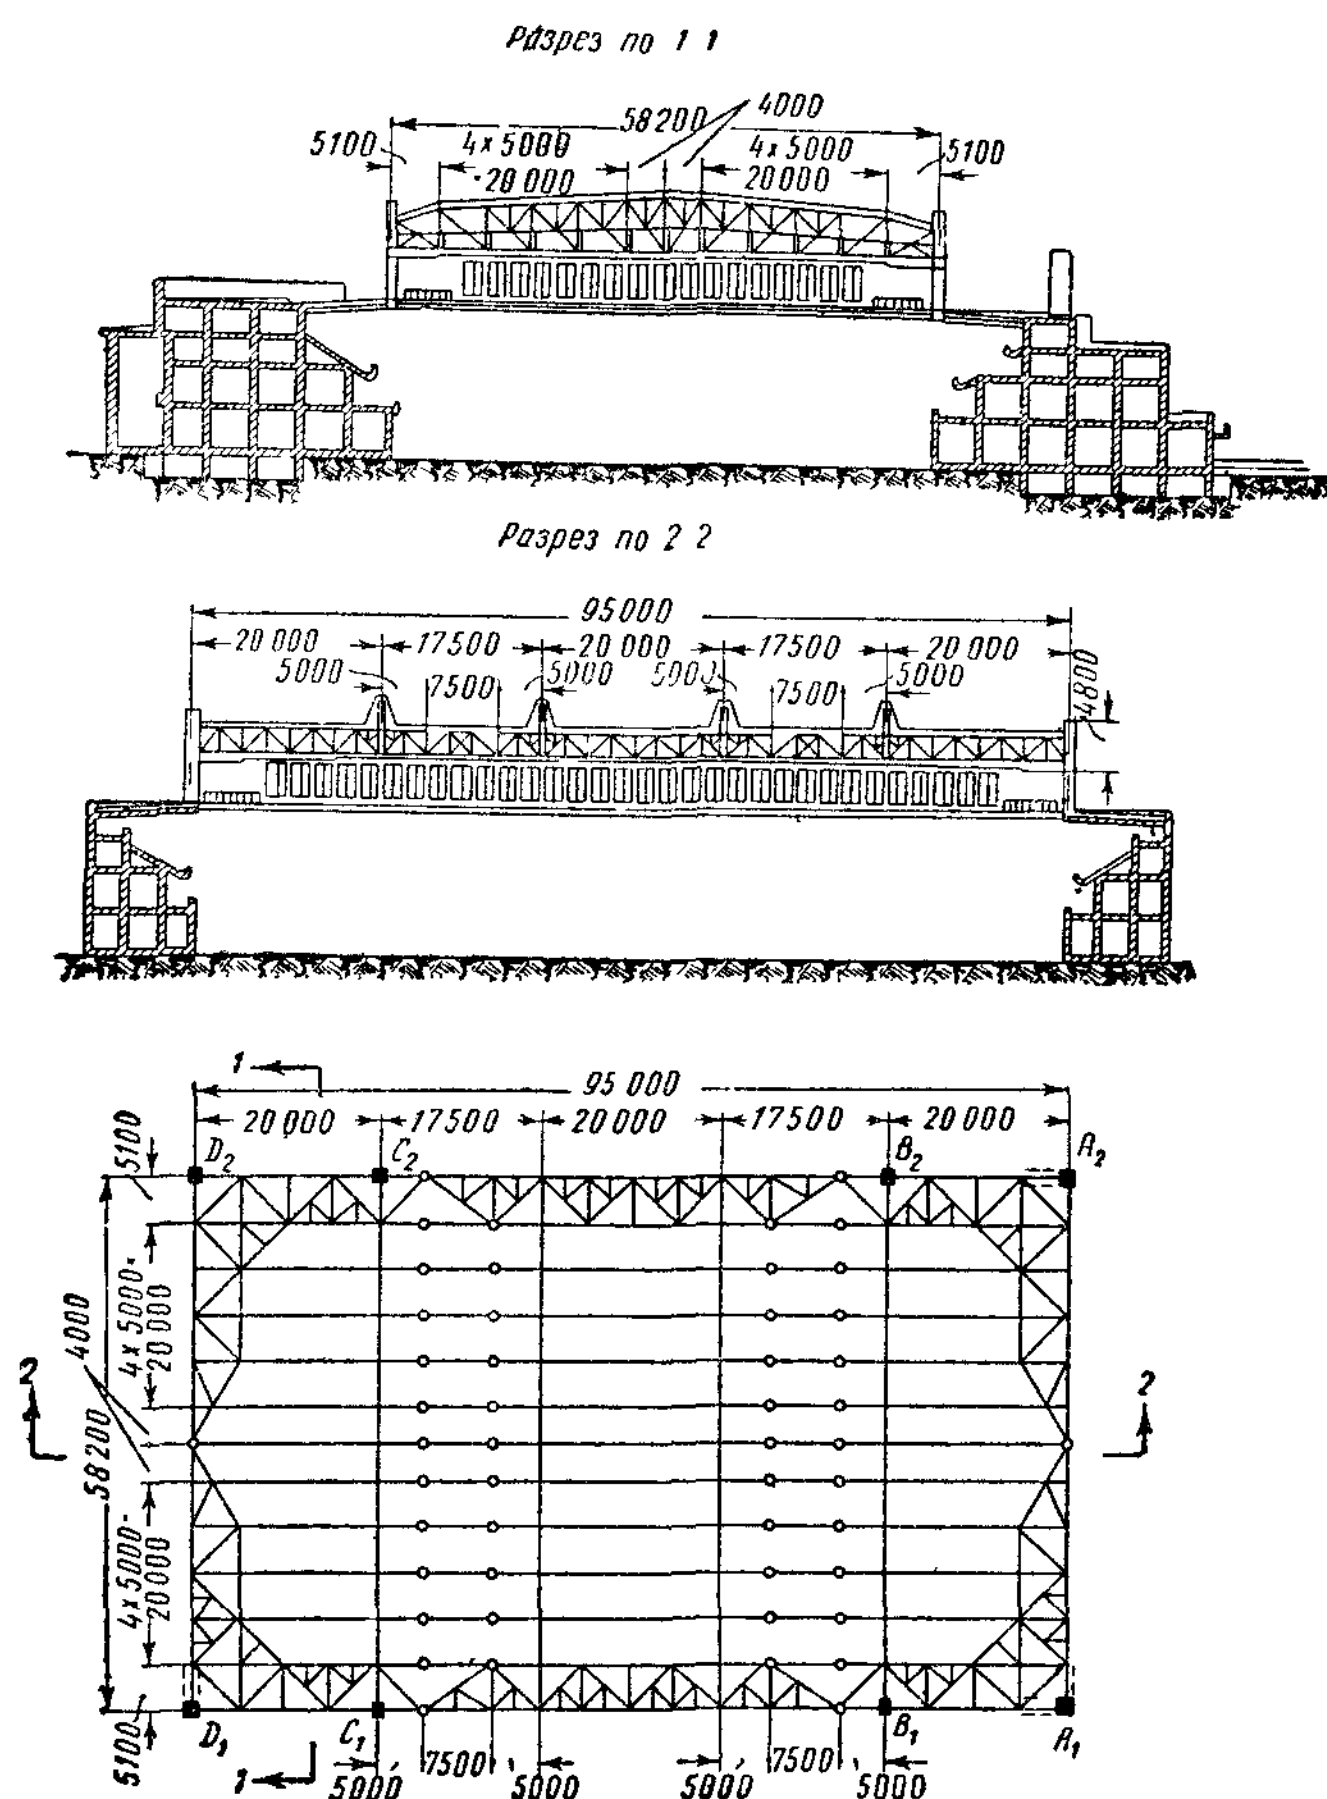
Балочная ферма — перекрытие зала в Льеже (Бельгия)
